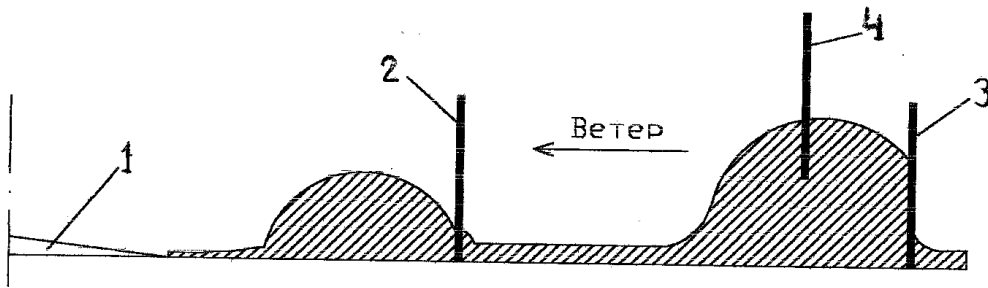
Схема установки и переустановки щитов: 1 – дорога; 2 – установка щитов; 3 – первая перестановка; 4 – вторая перестановка
